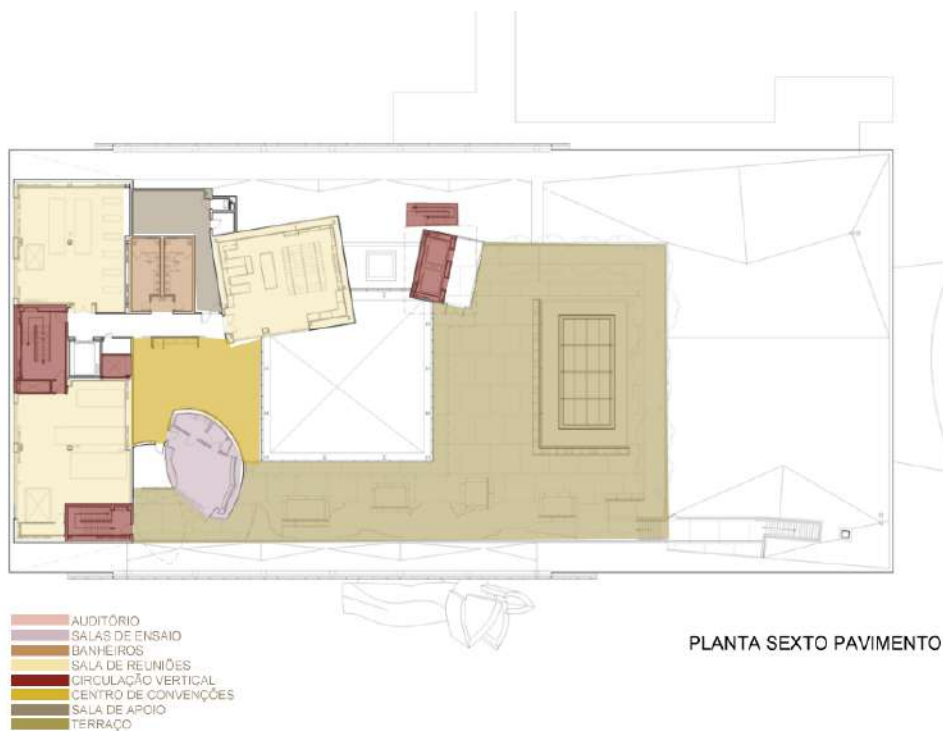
Planta sexto pavimento. Fonte: ArchDaily editada pela autora.
